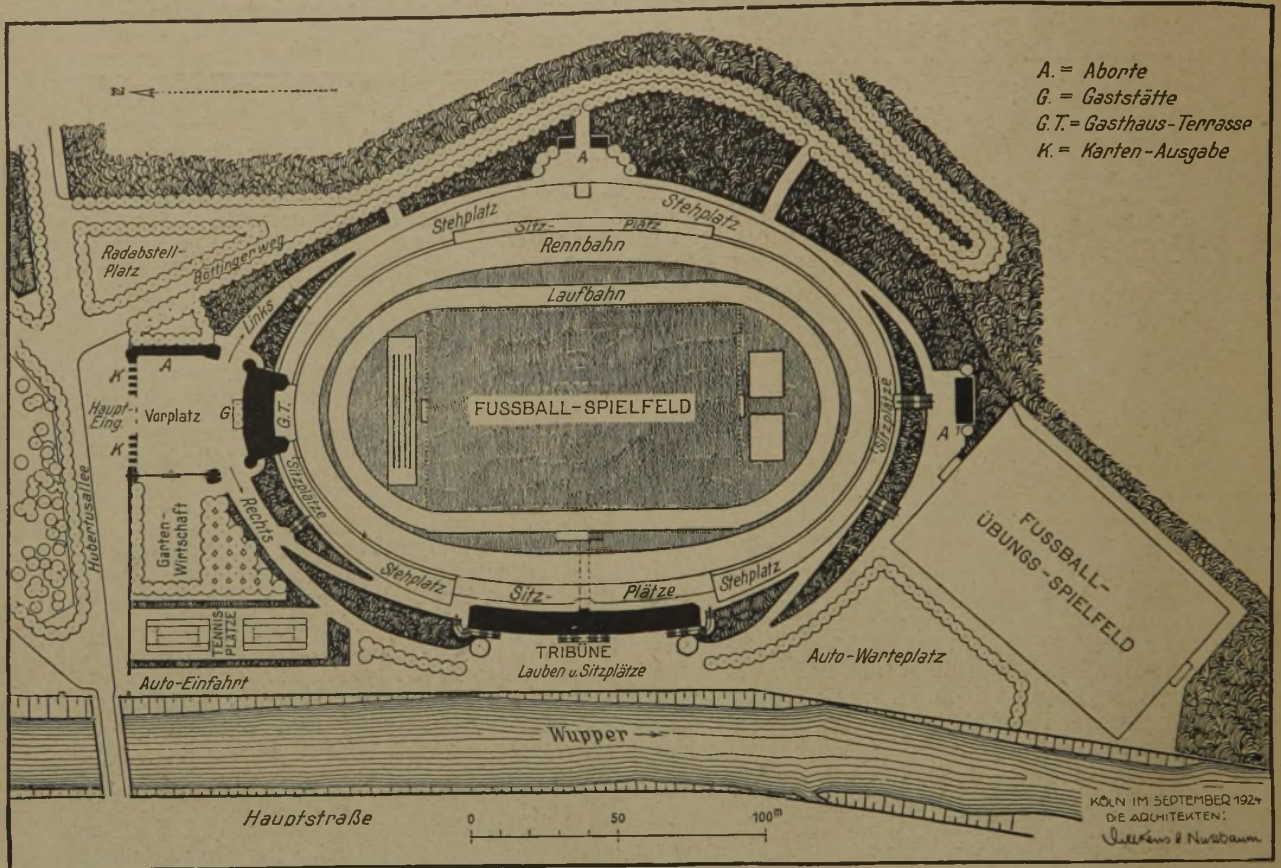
Lageplan des Stadions. (Maßstab 1:2500.)
